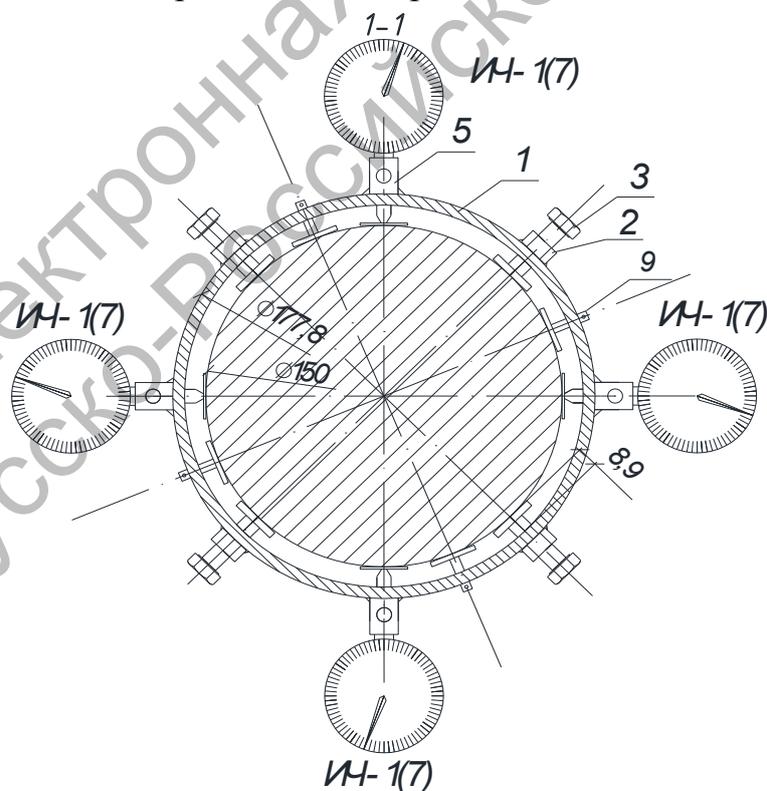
Кольцевая рамка при испытании цилиндрического образца, разрез 1-1
